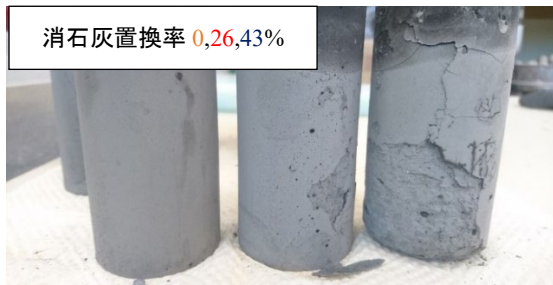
ひび割れと剥離した供試体表面の様子
